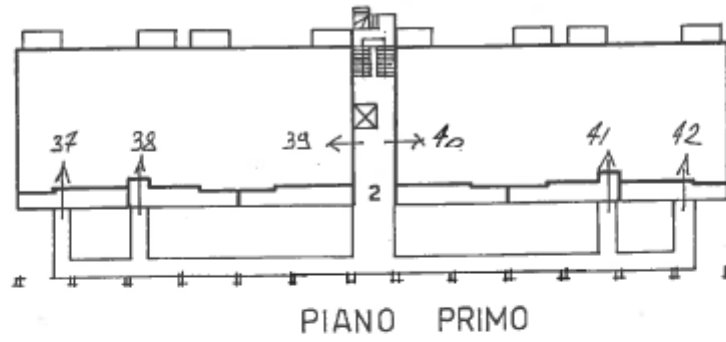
stralcio di elaborato planimetrico fuori scala NON presente in atti
